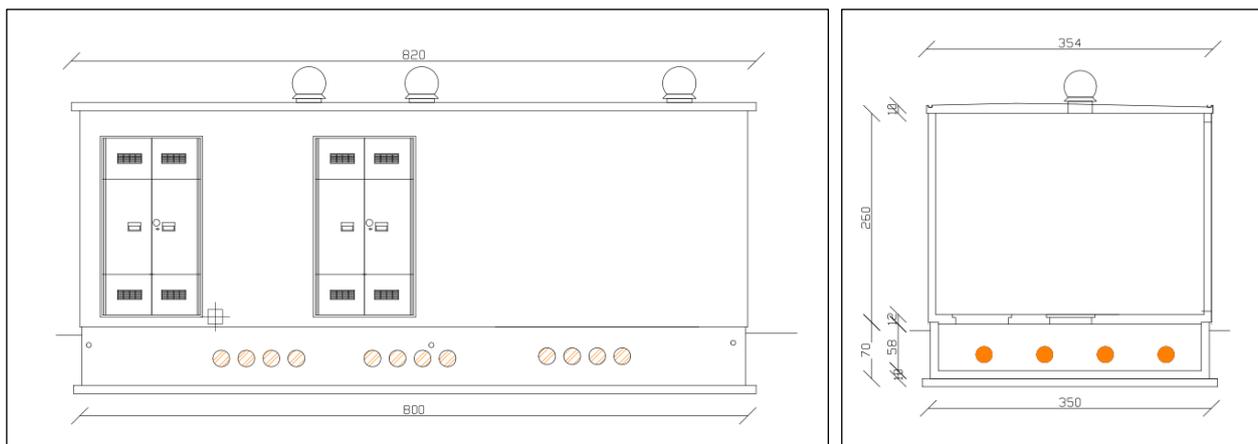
Prospetto lato campo e sezione tipo del locale monitoraggio con posizionamento su vasca di fondazione.
